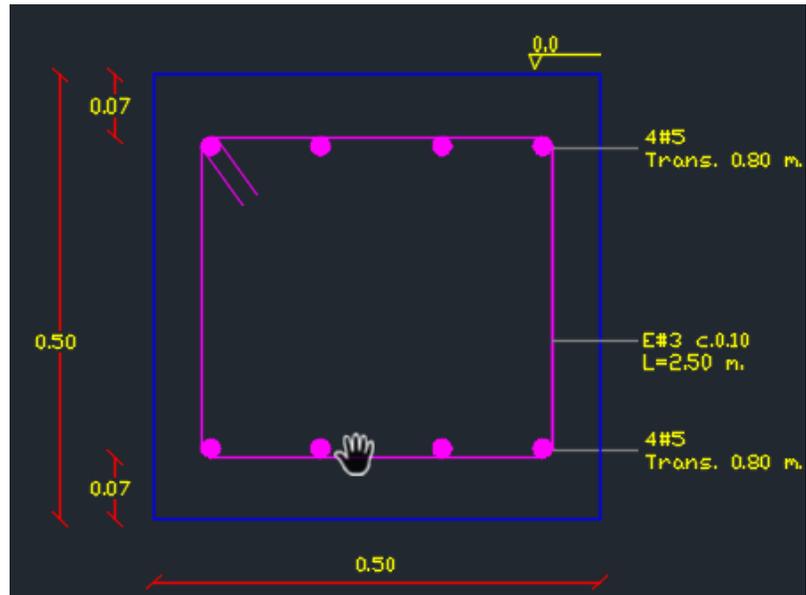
Viga de cimentación - Corte Z1-Z1
